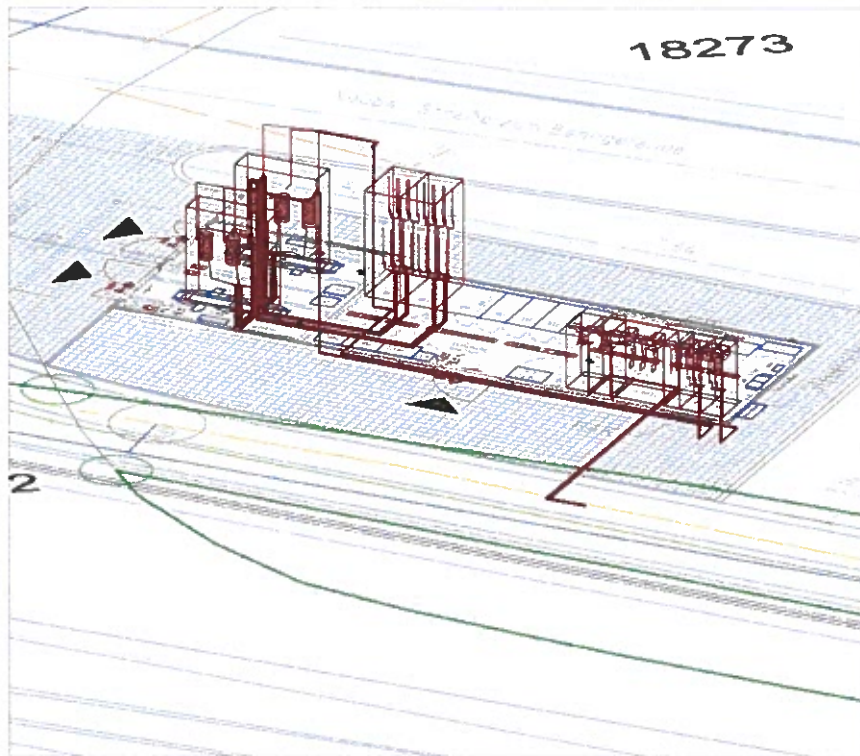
Räumliche Darstellung der modellierten elektrischen Betriebsmittel über dem Grundriss des Gebäudes.
